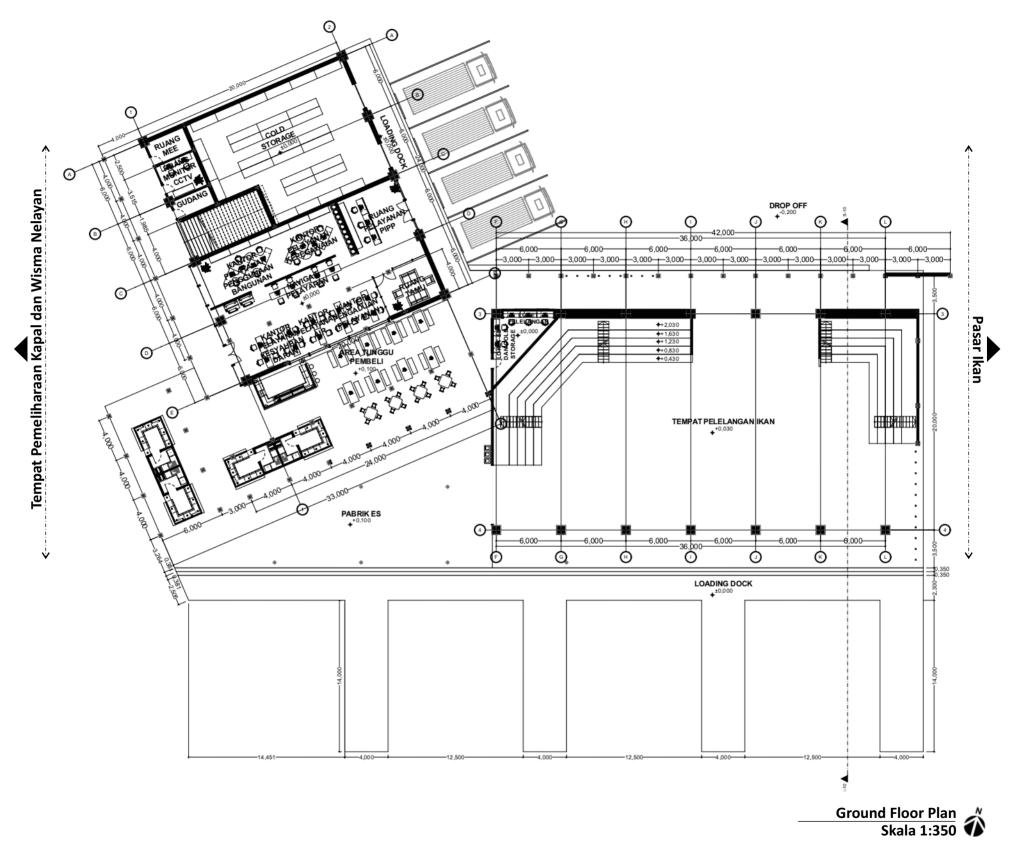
Site Plan Sumber : Penulis, 2022
